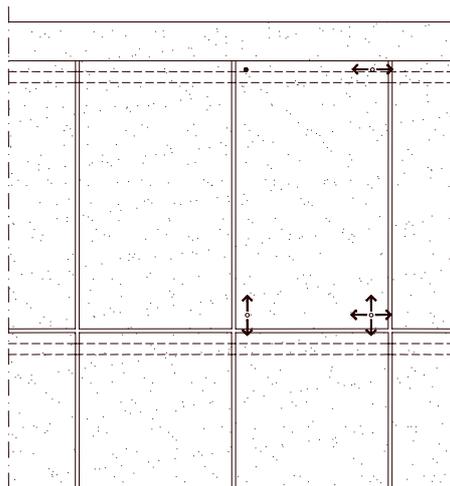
Elevação típica de um painel cortina com fixação no topo.
